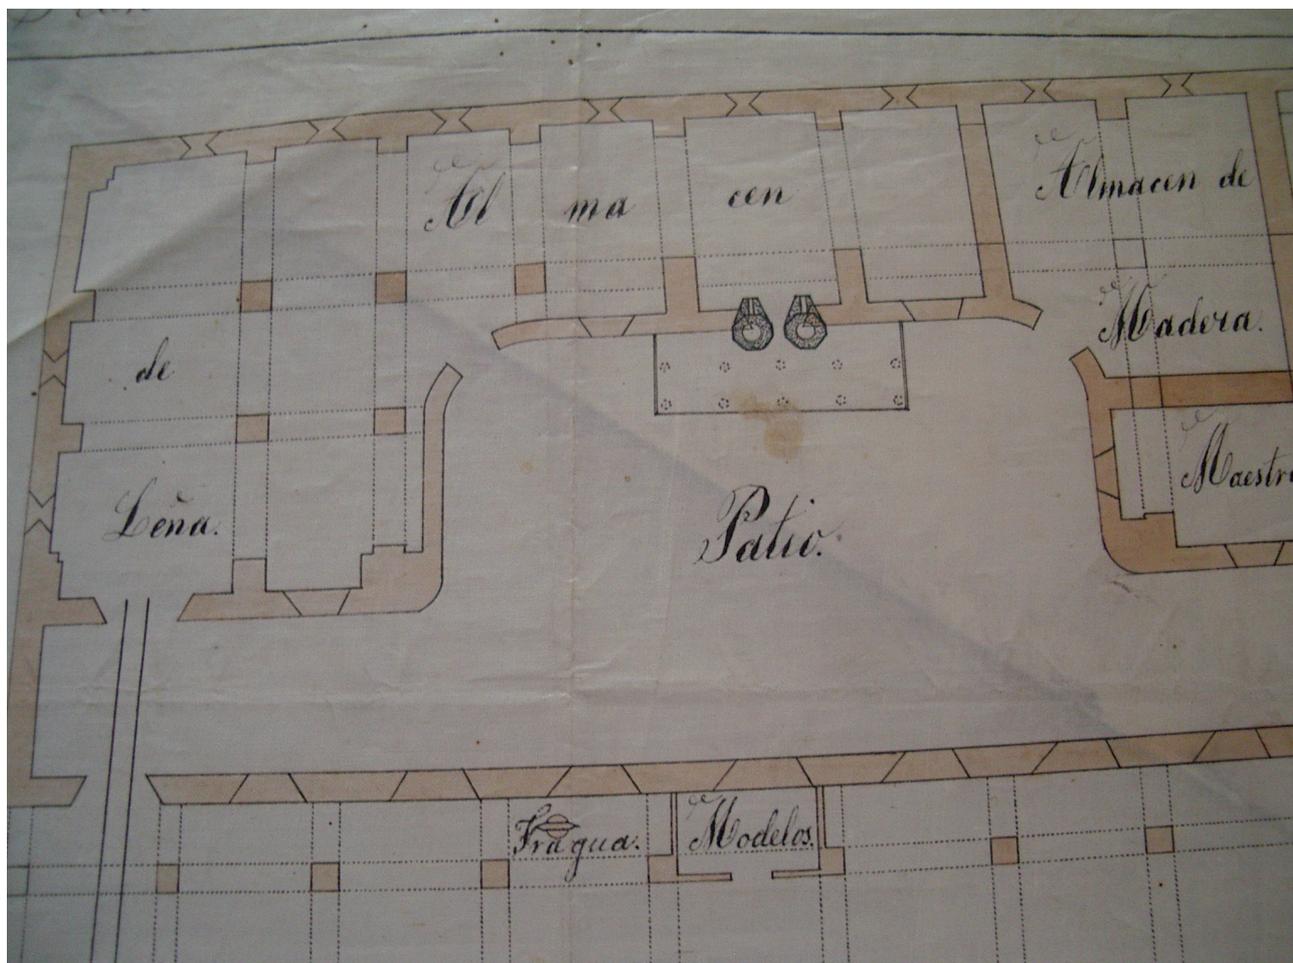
Detalle de la planta sureste proyectada hacia 1735 por Ignacio Sala. AFAS. Mapas y Planos.
